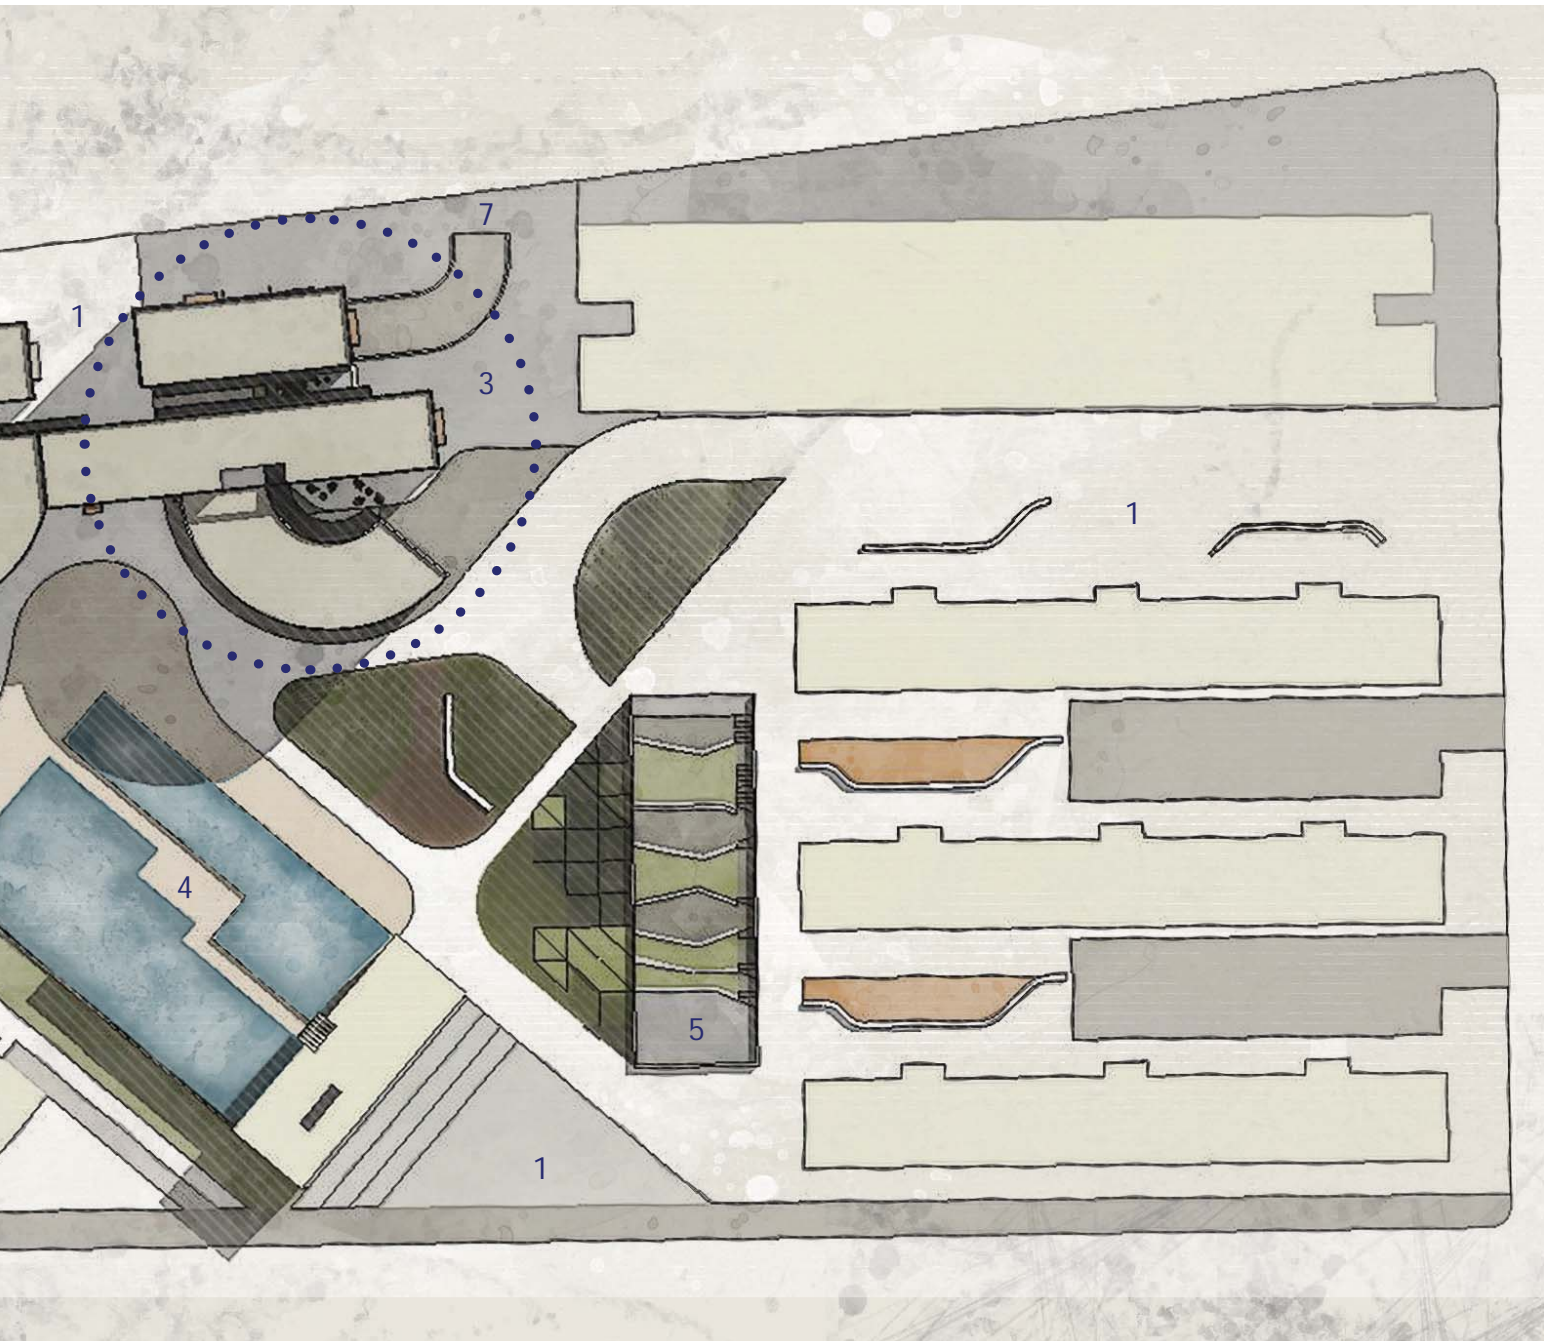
Planta de conjunto | Propuesta arquitectónica
